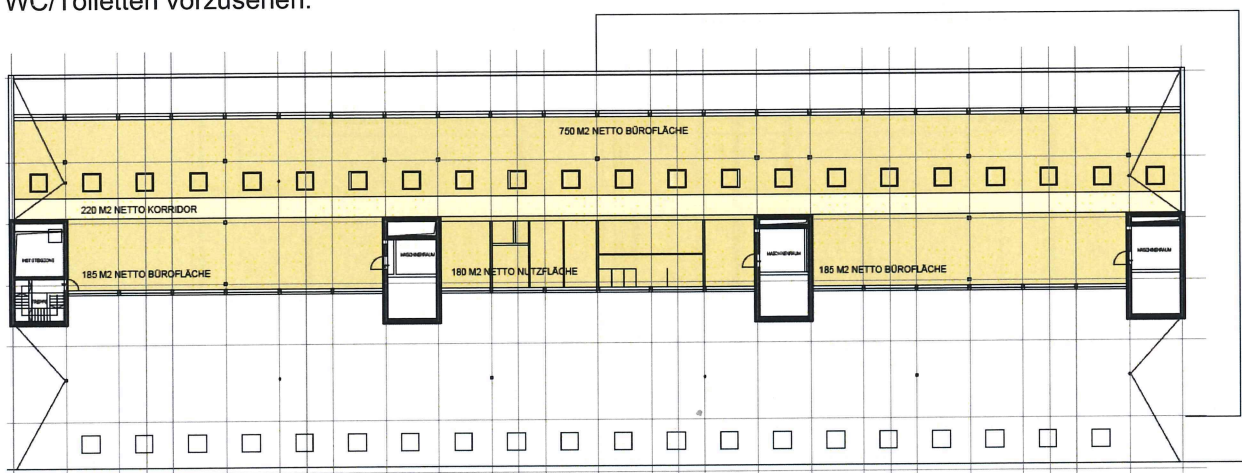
Variante 3 Grundriss 3. OG bzw. Dachfläche
